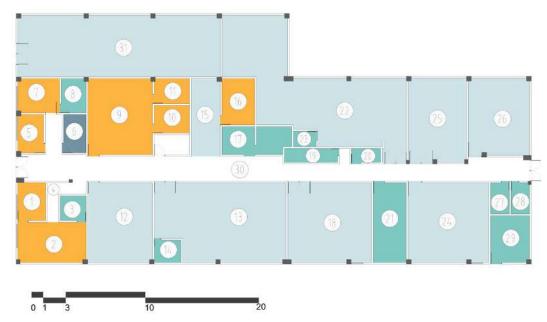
Planta 1 Bloque 47. Fuente: Equipo de diagnóstico.
